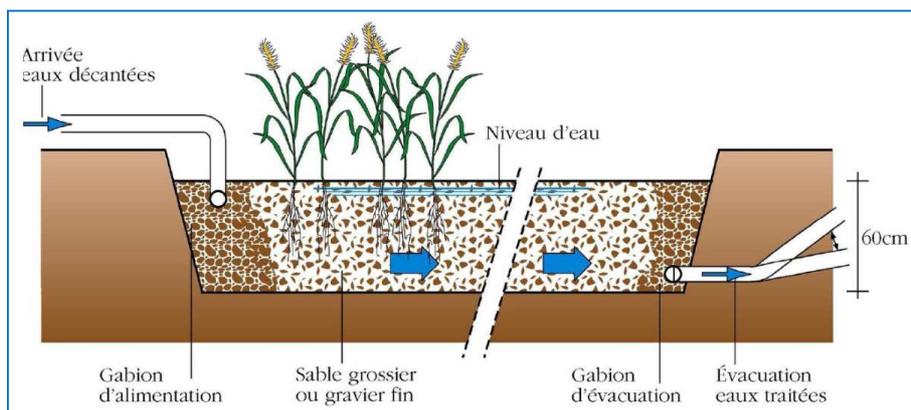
SCHEMA D'UN FILTRE PLANTE A ECOULEMENT HORIZONTAL [29]
